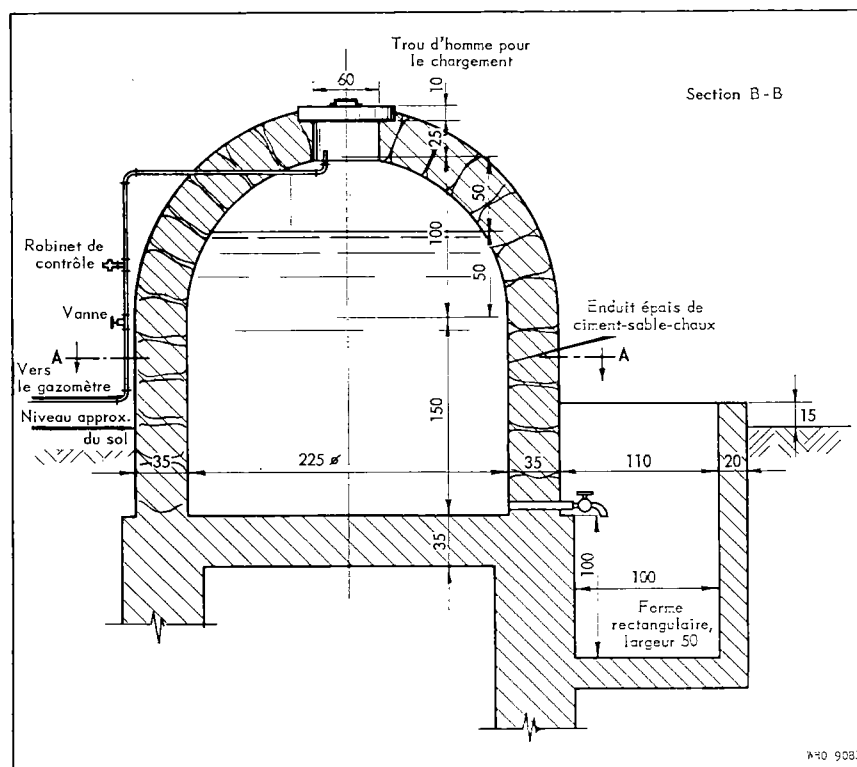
PLAN D'UN DIGESTEUR INDIVIDUEL
